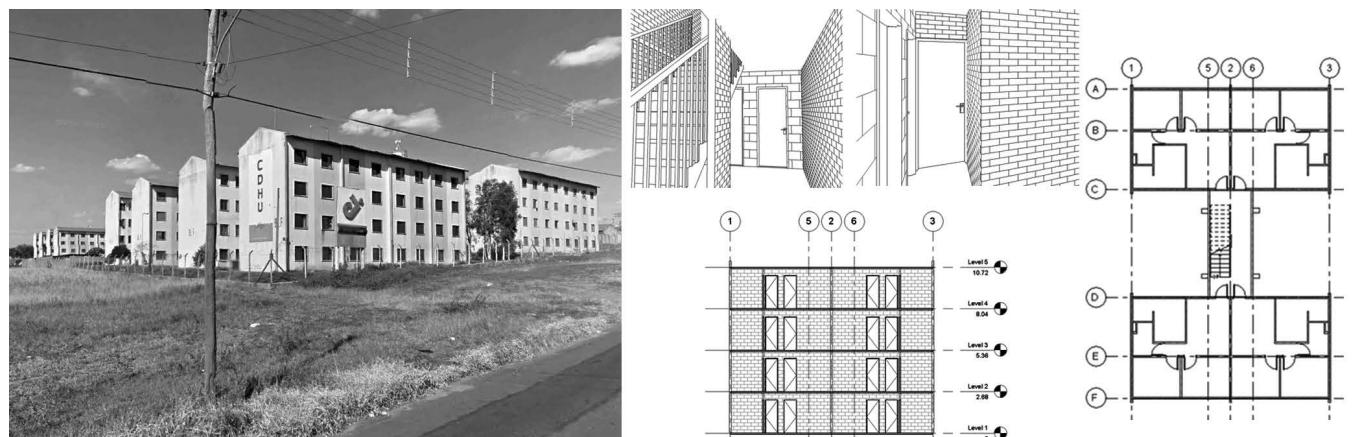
Conjunto Hab. Dr. José Luiz Blumer e Pref. Virgílio Ometto. Imagens do local, planta do pavimento tipo e vistas do modelo.
